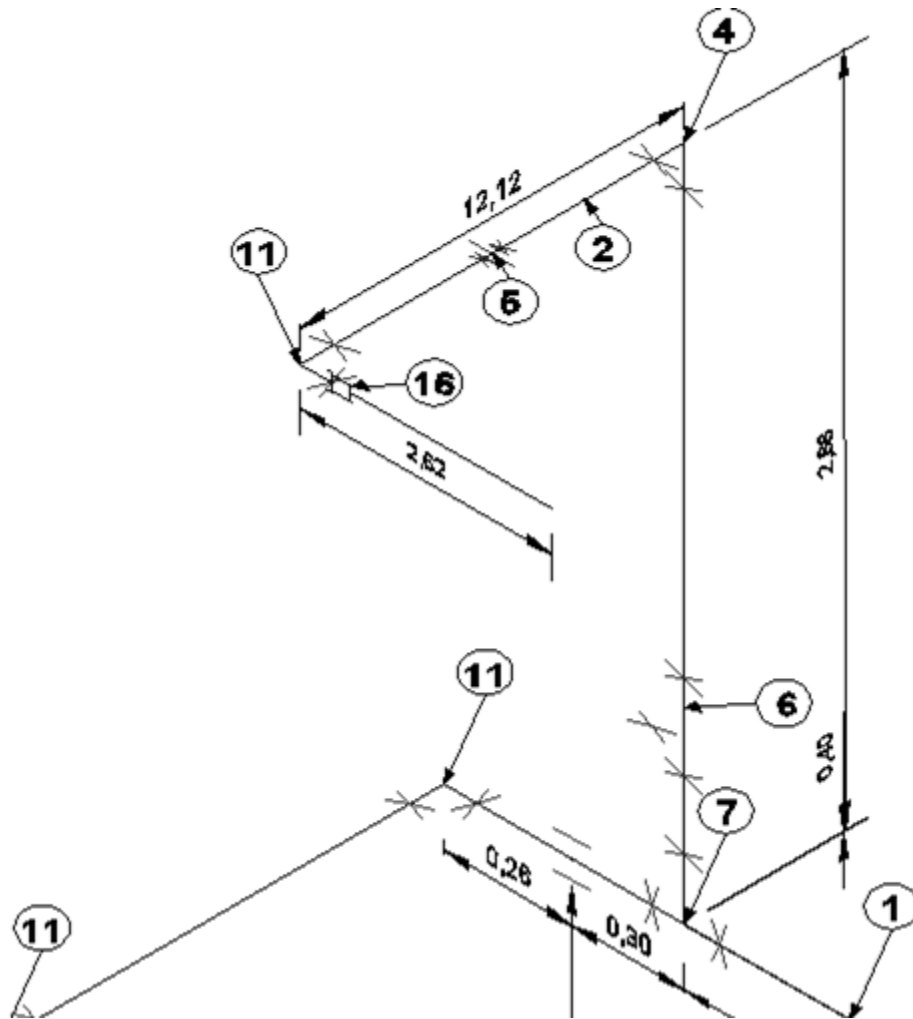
Plano del inicio de la red en el rediseño planteado
